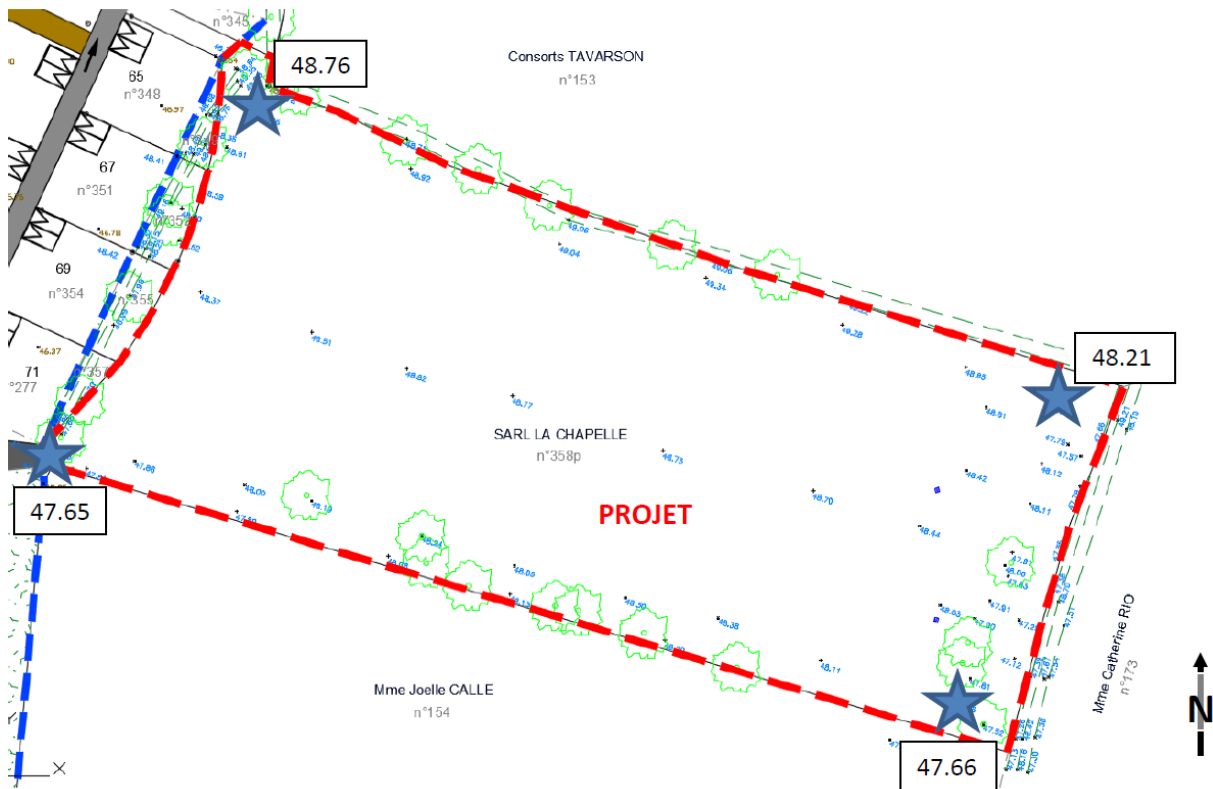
plan topographique du projet d'extension Est (source : Premier plan, PA2, 2021)
